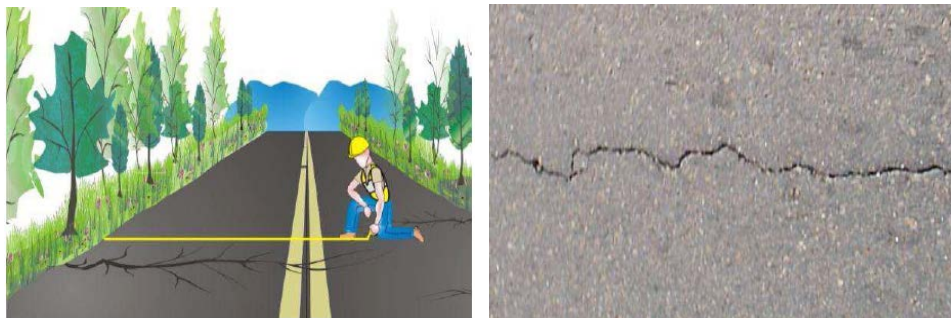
Apariencia de un pavimento afectado por Grietas transversales.
